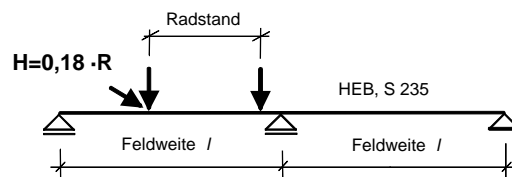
Kranbahnträger mit reduzierter Horizontallast
